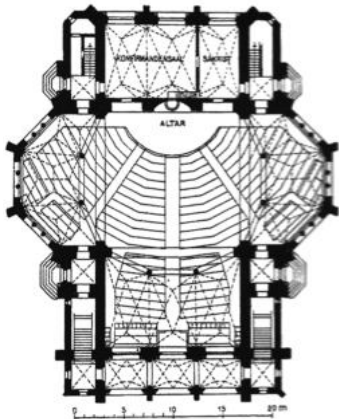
Grundriss (Evangelischer Oberkirchenrat)
